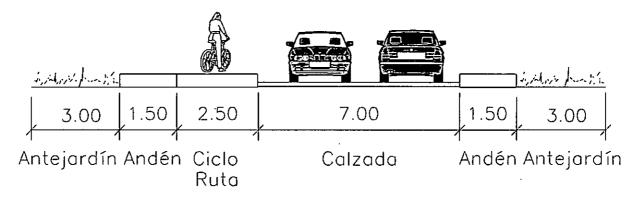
Sección vial Calle 28 entre carreras 87 y 87C. Fuente: Equipo técnico Plan Maestro API_39 Universidad de Medellín.
